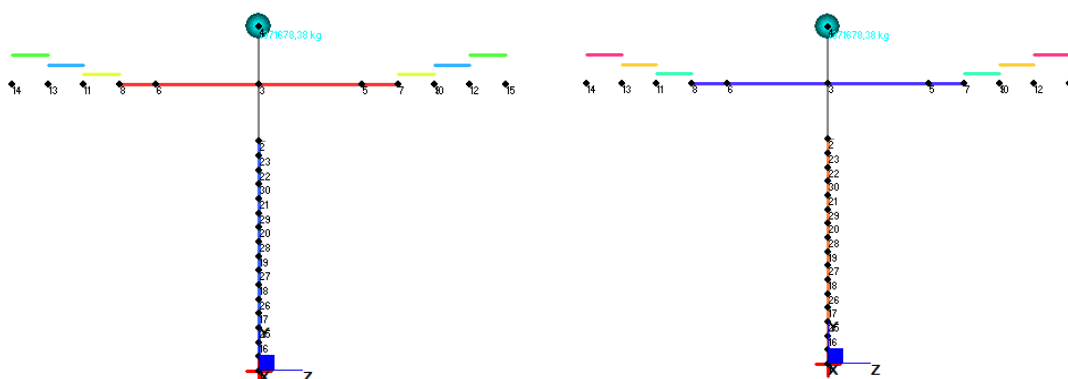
Modello pila 12.50m - Pila e pila fessurata
